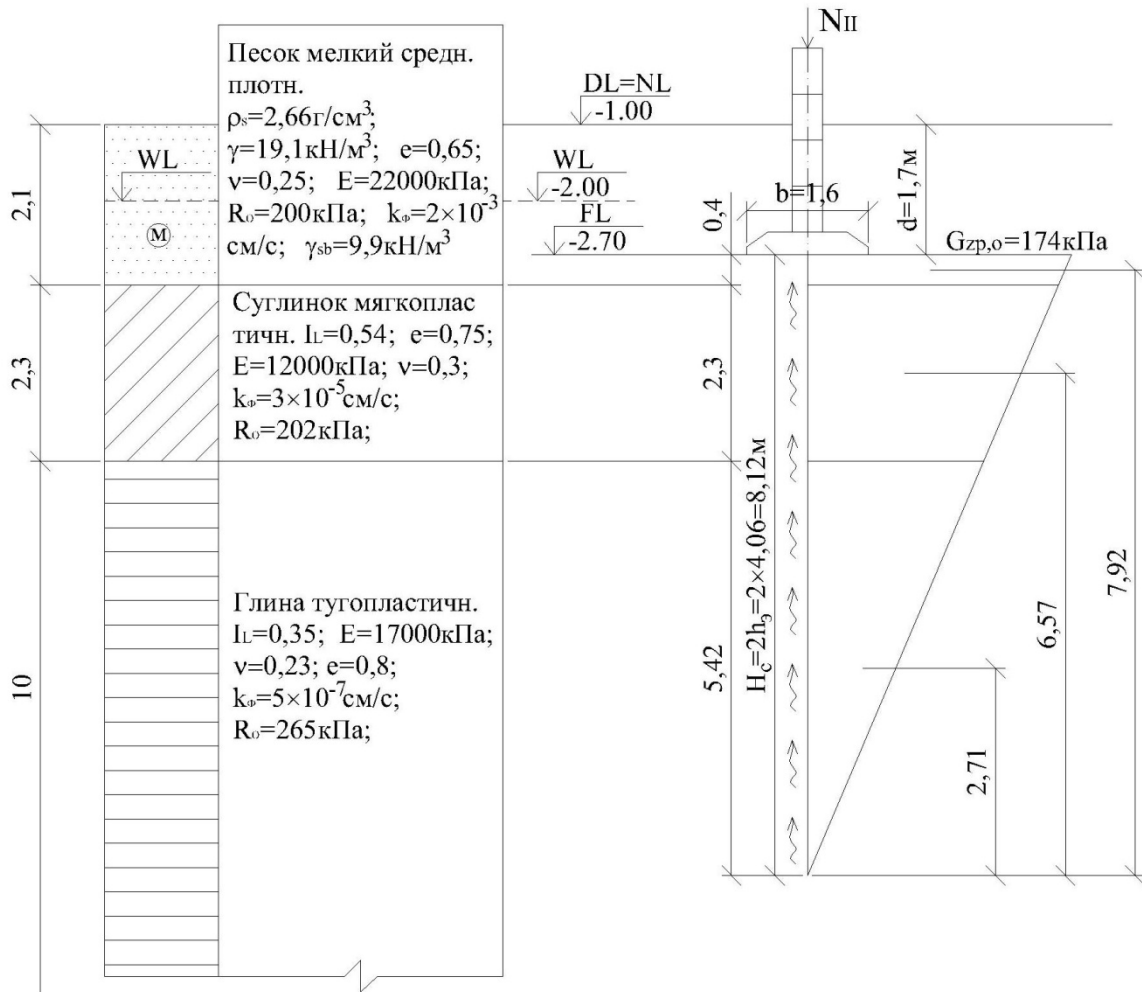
Схема к расчету стабилизации осадки во времени
